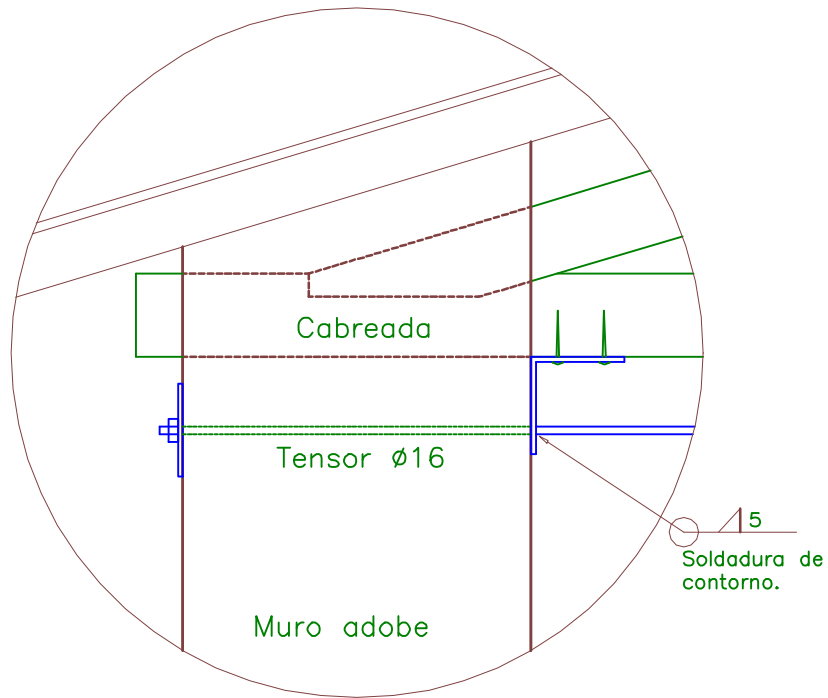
Detalle del apoyo de la viga reticulada y su vinculación al muro.
